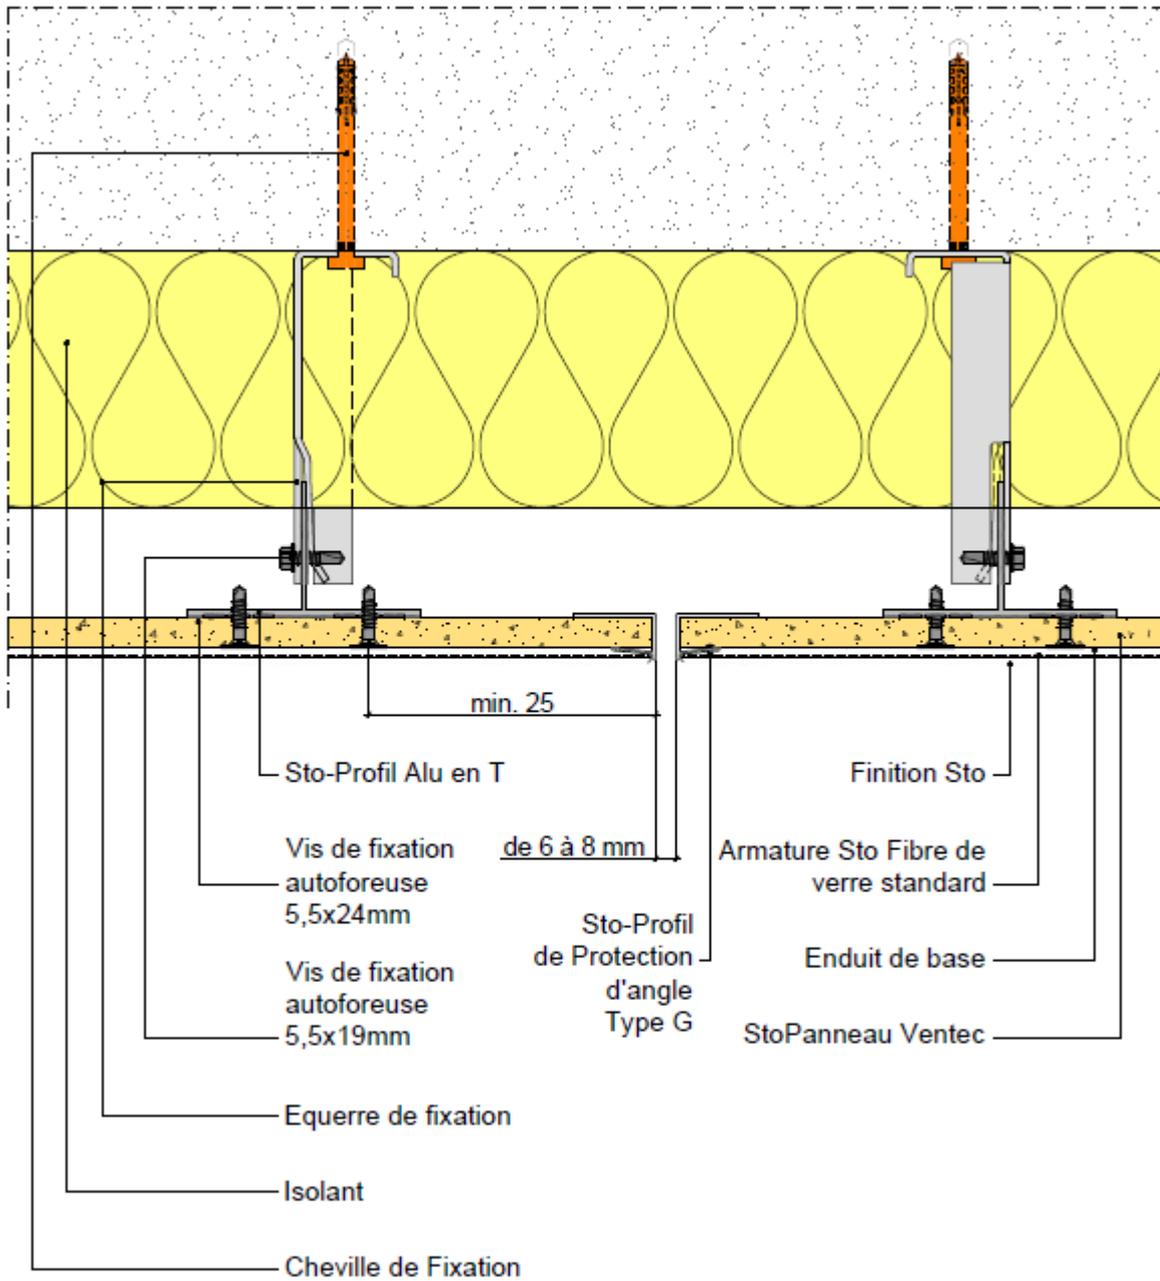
Coupe horizontale - Fractionnement à joint ouvert - Ossature aluminium
